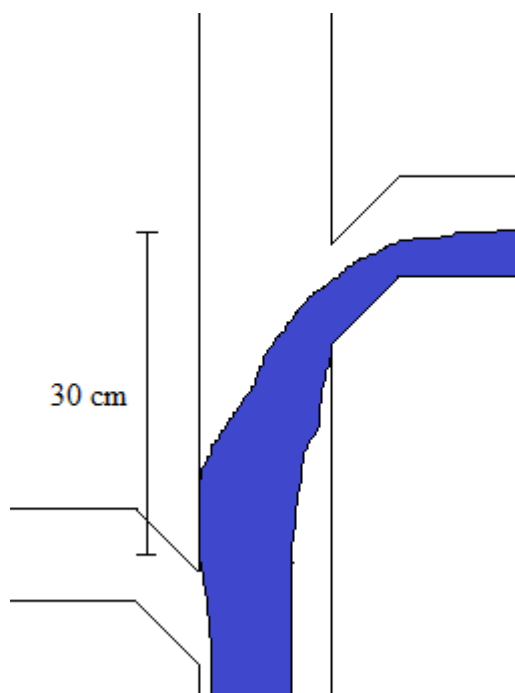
Proposta de disposição construtiva – Exemplo ligação em forquilha
